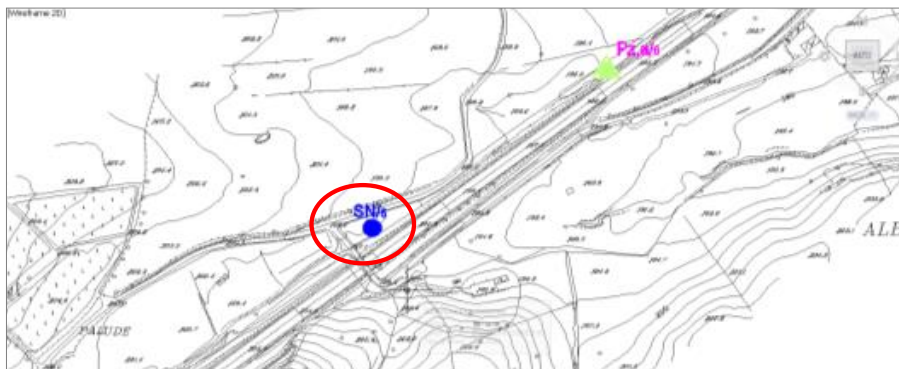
FOTO SATELLITARE CON PROIEZIONE DEL SONDAGGIO: SN5
